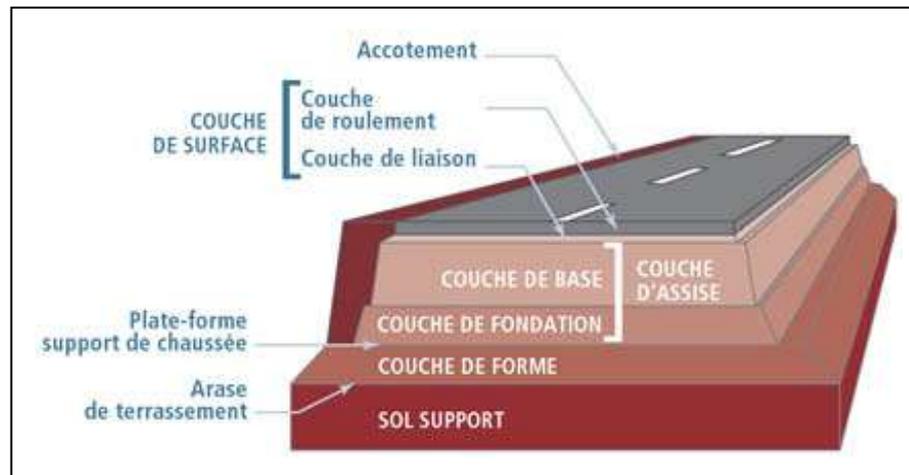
Structure d'une chaussée (d'après audition USIRF, 2011)
